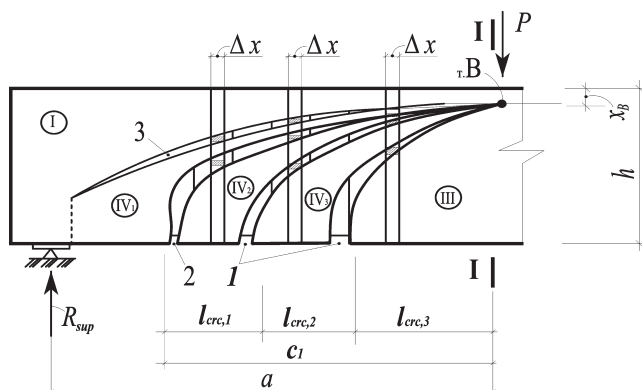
Расчетная схема единичных полосок железобетонного составного стержня на участках с наклонными трещинами
